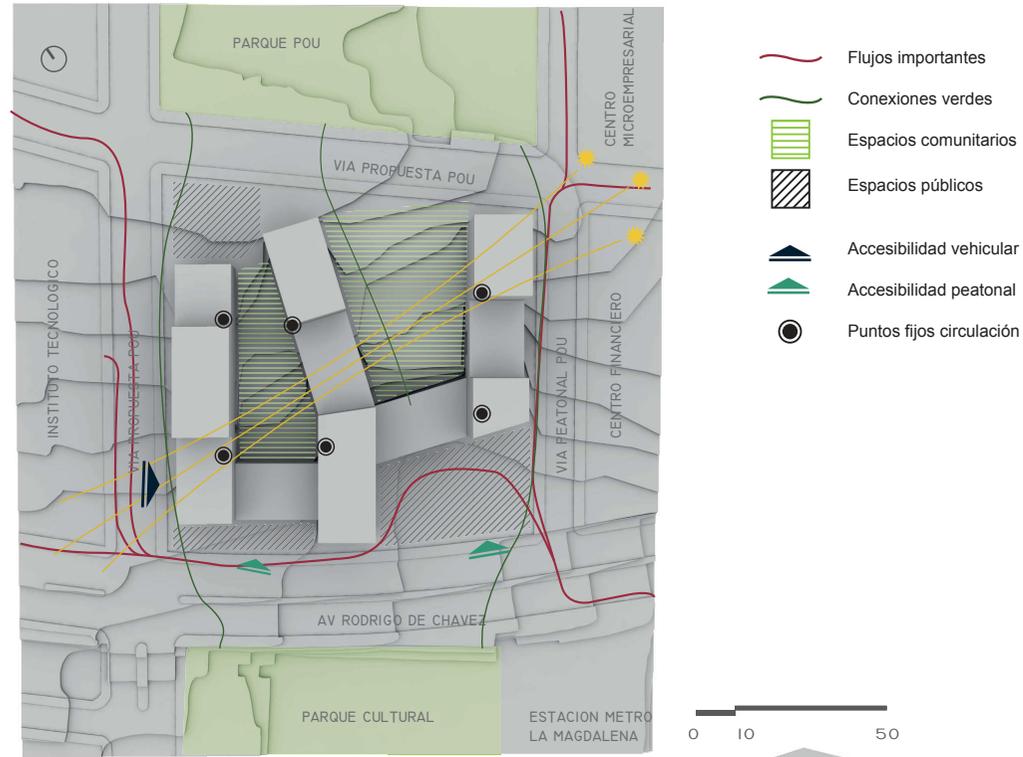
Propuesta 3 plan masa - implantación y estrategias
